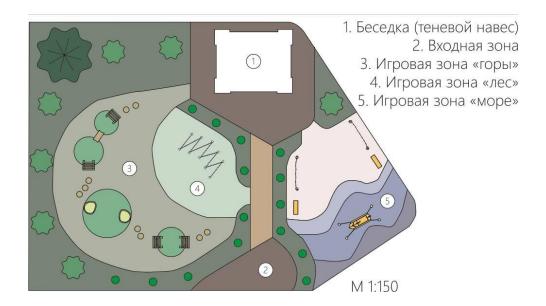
Разработанный генеральный план площадки для детей 6-7 лет
